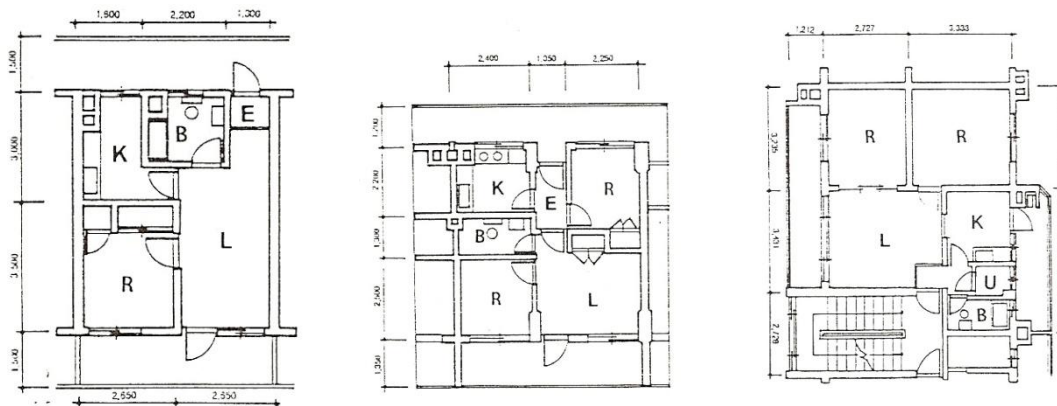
Grundriss der Mapo-Wohnhochhaus-Siedlung mit Größe 30m², 40m² und 53m²
